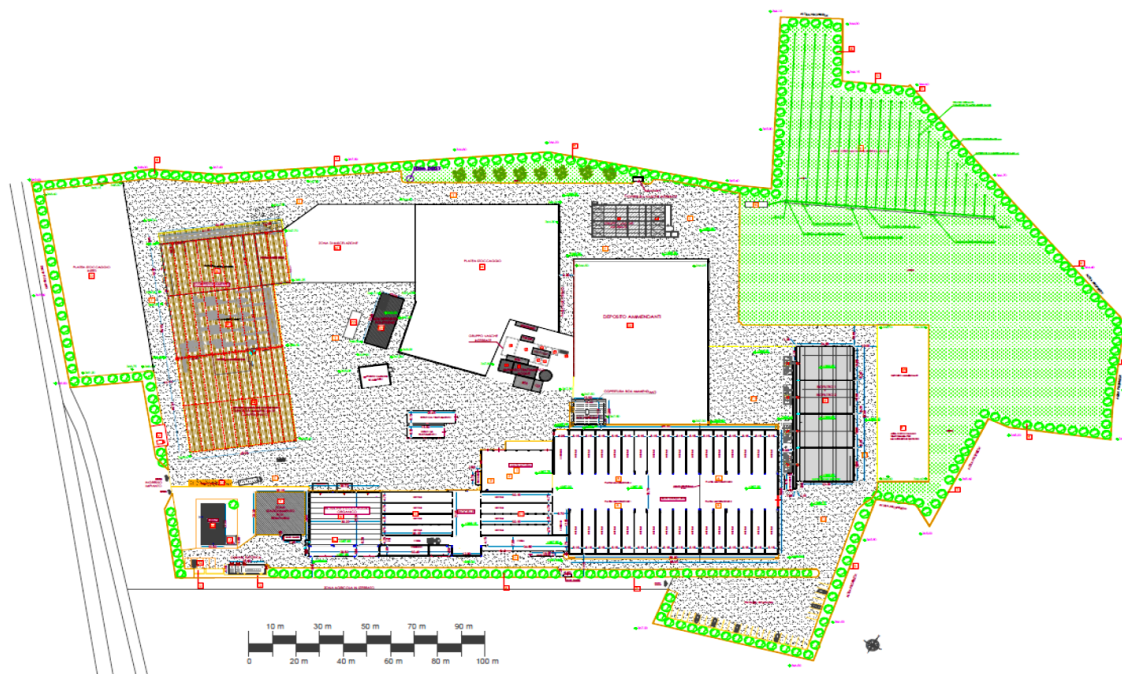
Planimetria generale Primo stralcio funzionale al 31.12.2018
